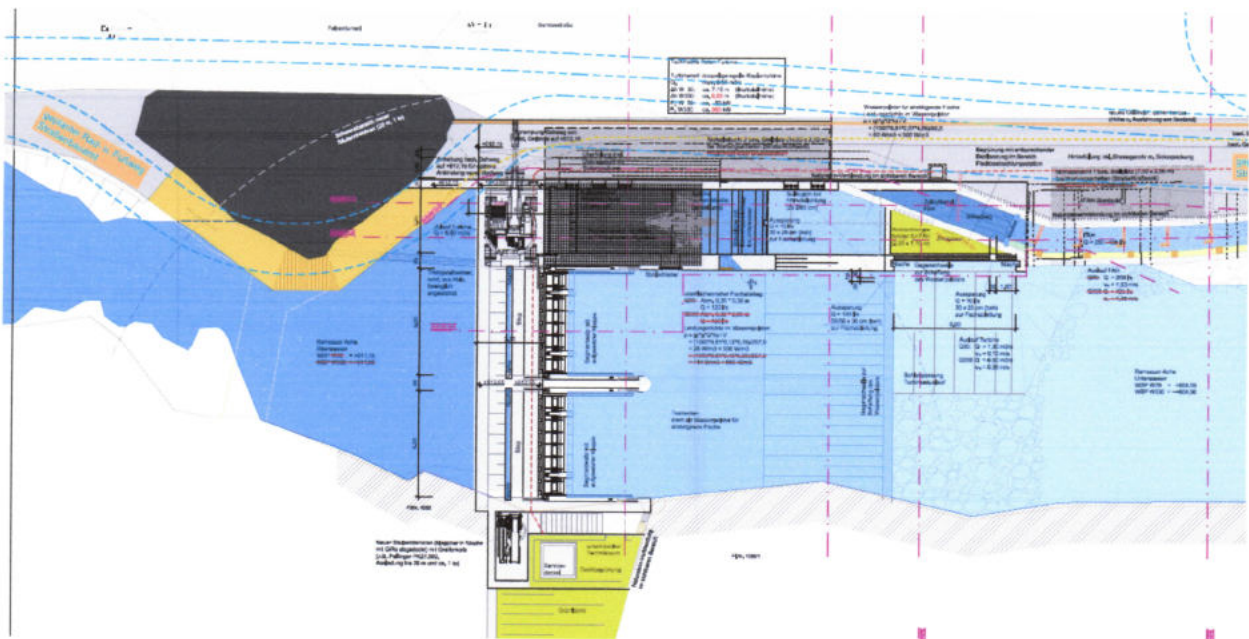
Übersichtslageplan der Wasserkraftanlage (IB Ederer Planungsstand mit Index 01.03.2021 - Ergänzung 15.03.2021).
